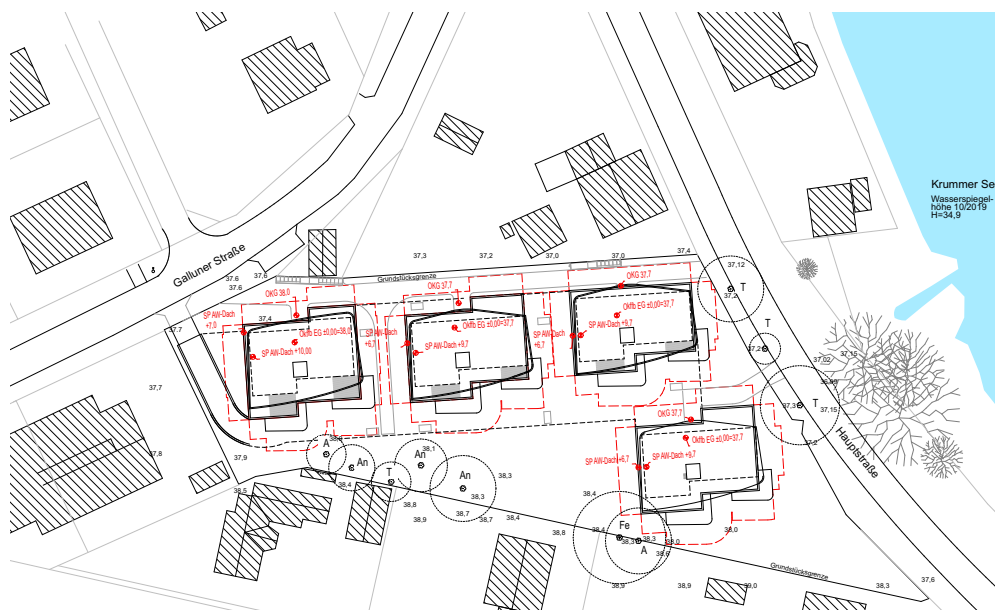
Lageplan mit Darstellung der geplanten Bebauung und der Abstandsflächen
